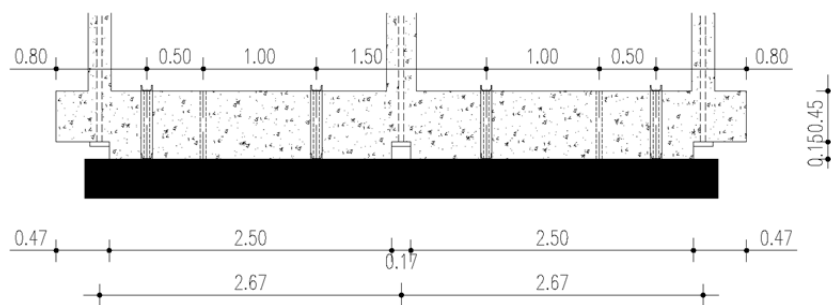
Pontos de fixação da viga de fundação à plataforma sísmica (dimensões em m)
